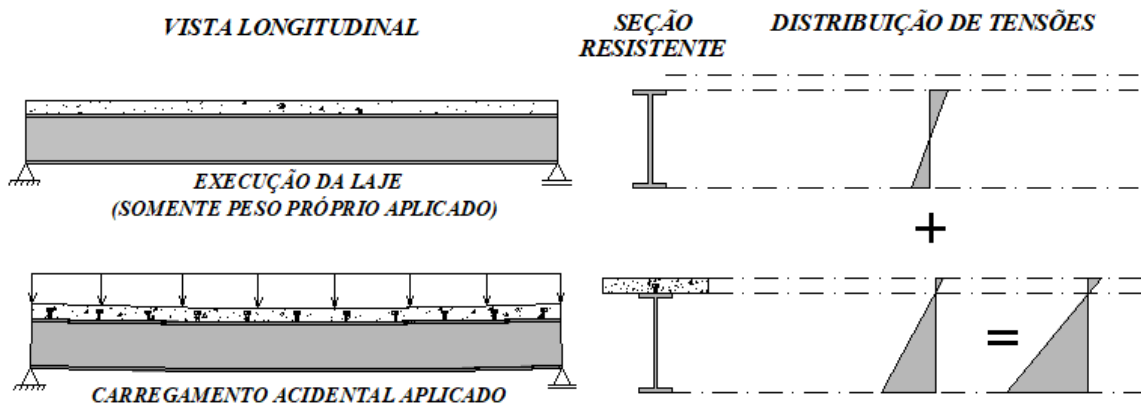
Estruturas mistas não escoradas – Fonte: Adaptado Fabrizzi (2007).
